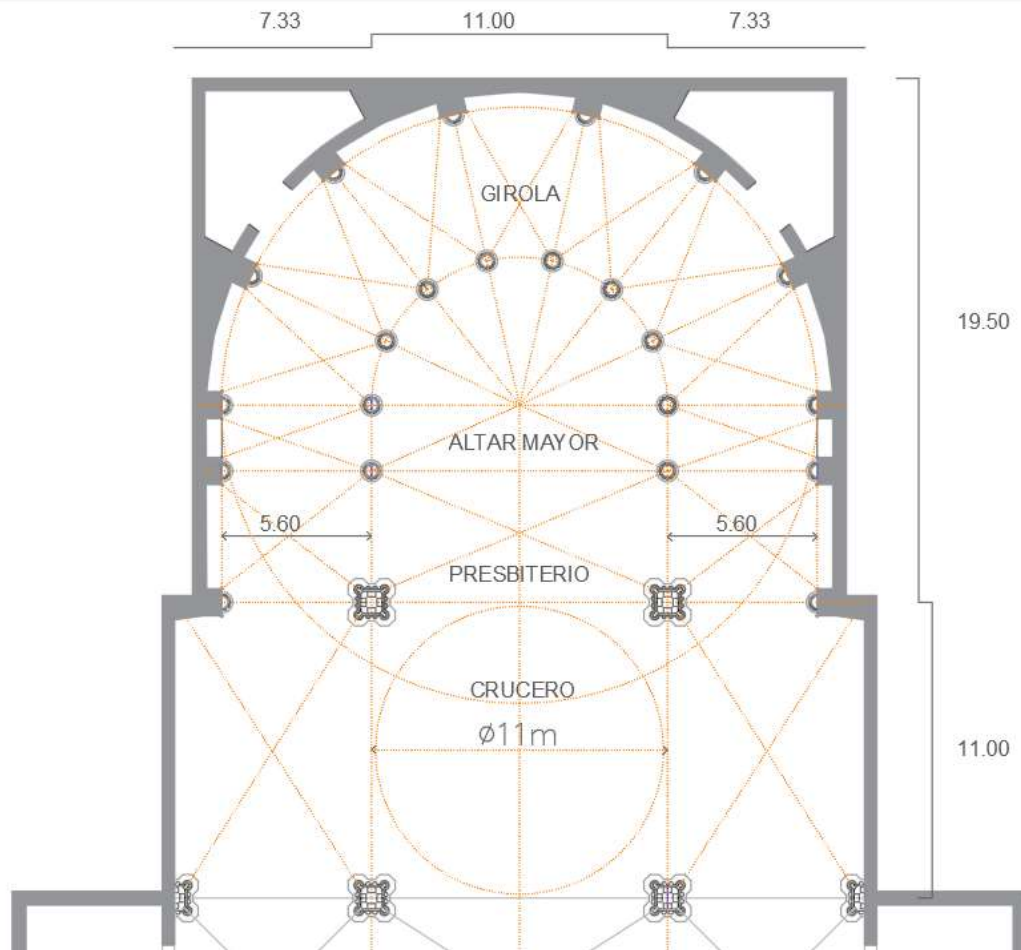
, detalle en planta de la ampliación del proyecto hacia el ábside. Levantamiento y dibujo del autor.
